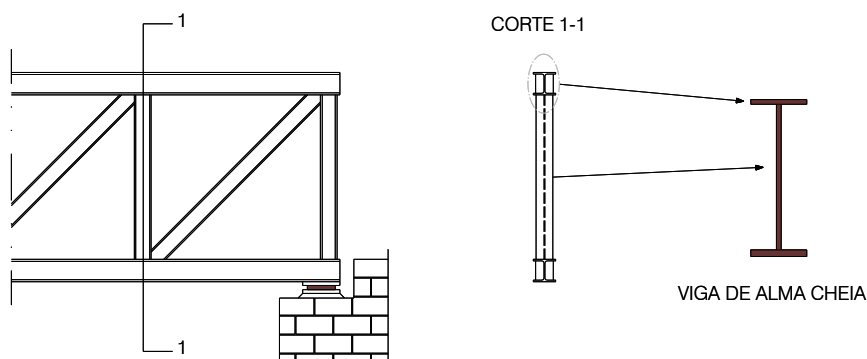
Esquema de funcionamento estrutural da treliça metálica
